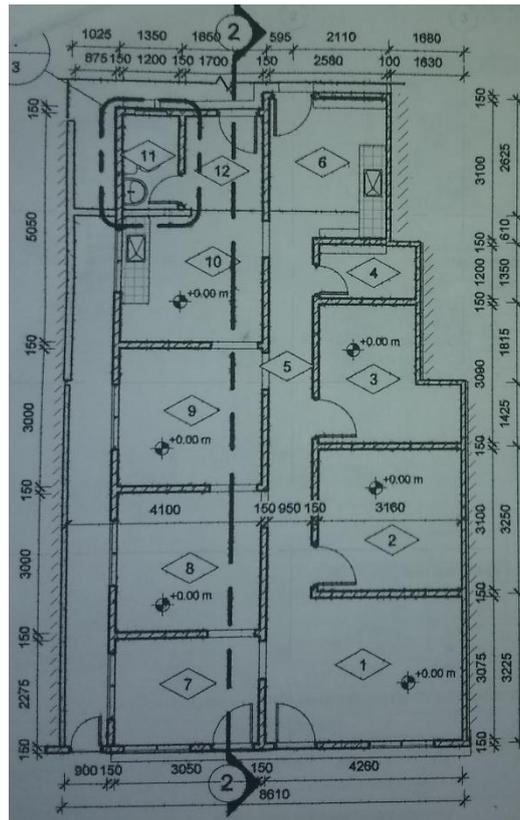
Planta de la vivienda de Tipología III. Fuente: Foto tomada por la autora al informe del proyecto facilitado en Planificación Física.
